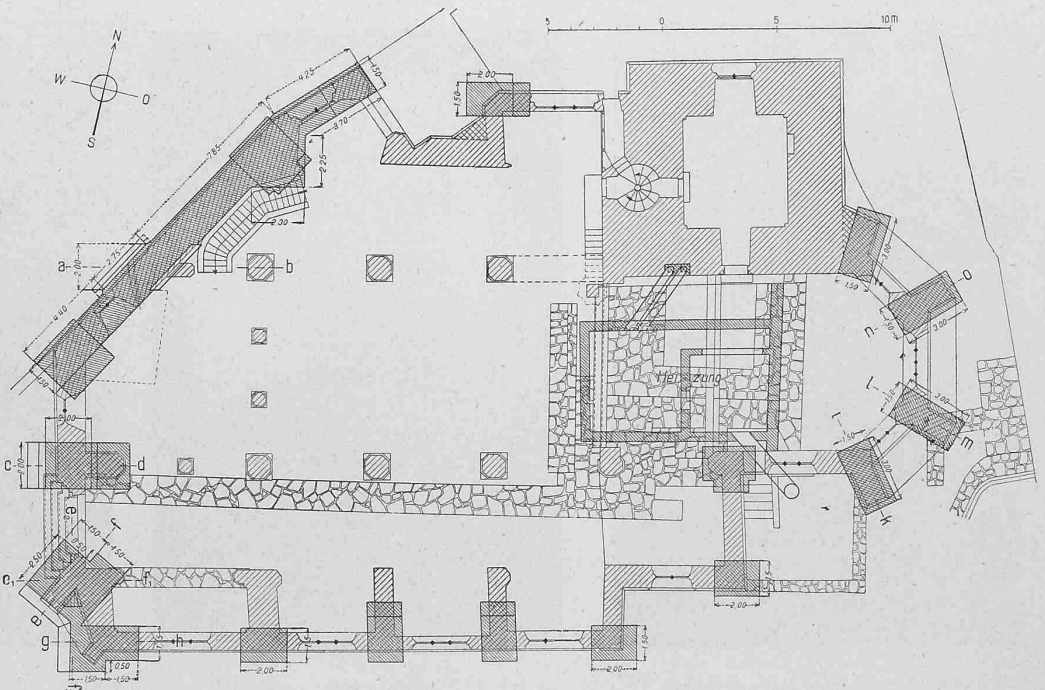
Fundament-Grundriss der deutschen Stadtkirche in Biel. — Masstab 1 : 300.
